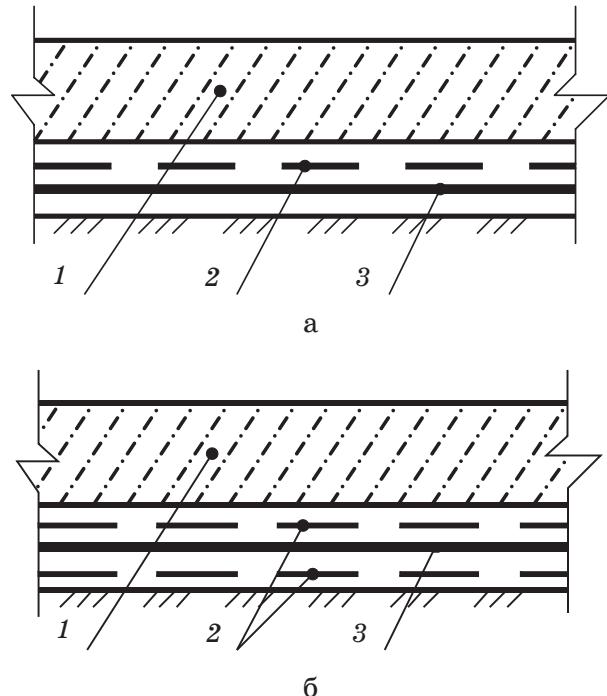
Конструкции бетонопленочных облицовок с использованием геомембраны: 1 – защитное покрытие из бетона; 2 – защитная прокладка из геотекстиля; 3 – противофильтрационный элемент из геомембраны
